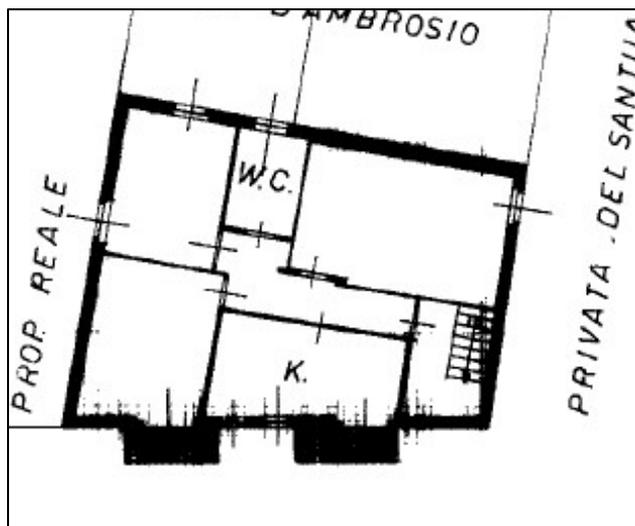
Planimetria catastale sub. 4 del 24.12.1980
